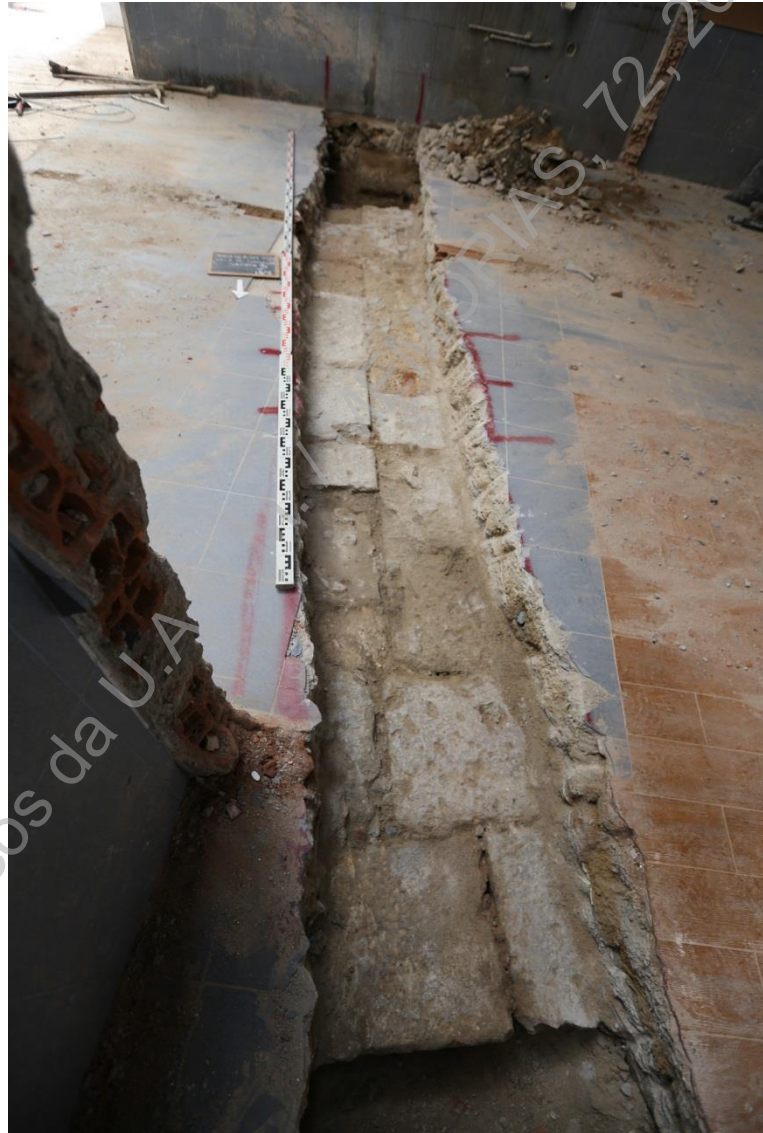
(IMG_1736) – Primeira fase de escavação da sapata 3 (N/S).
